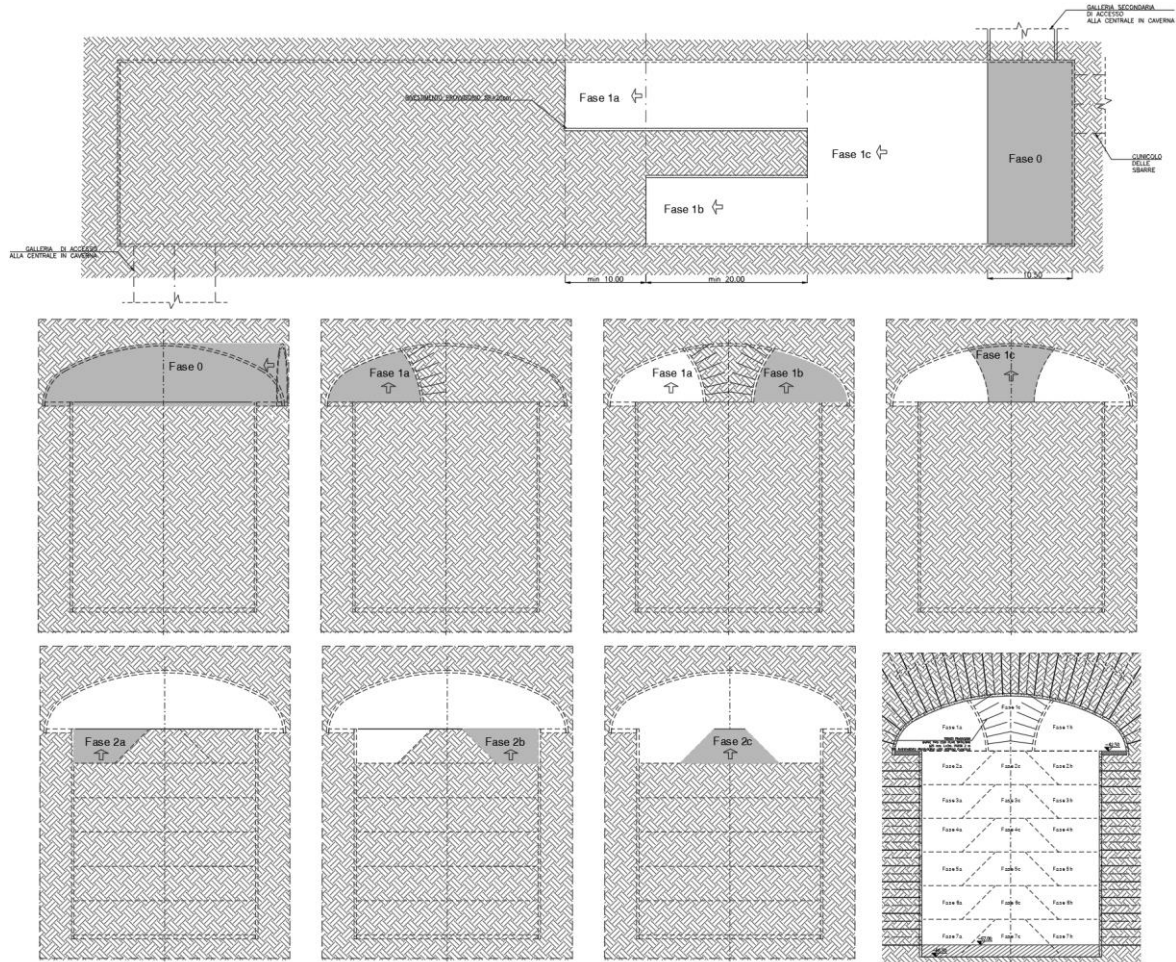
Fasi di scavo della Centrale in Caverna, planimetria e sezione trasversale
